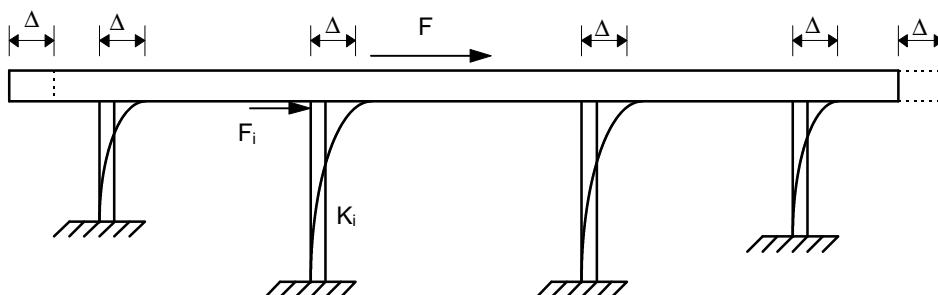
Distribuição, entre os pilares, do esforço longitudinal aplicado à superestrutura.
